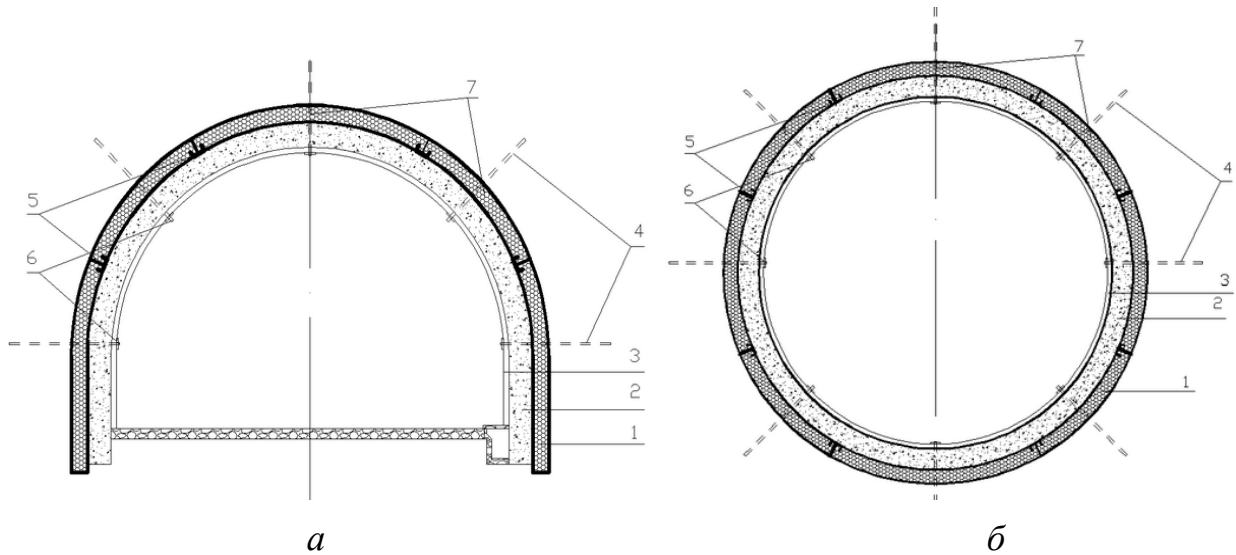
Конструкція двошарового бетонного кріплення зі збірним податливим шаром:
